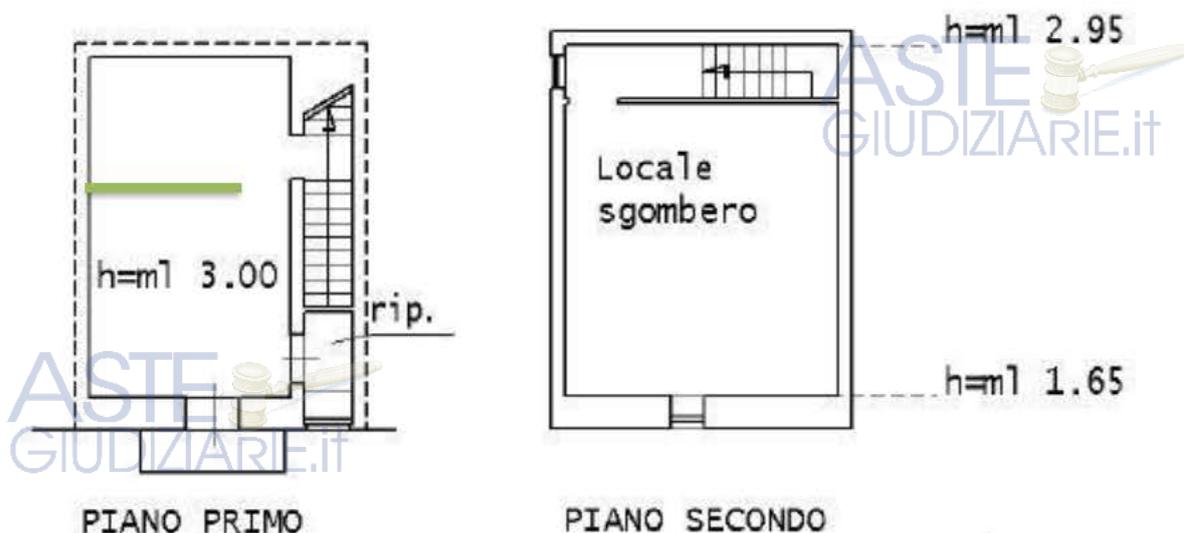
Stralcio della planimetria catastale. Piano primo e sottotetto.
